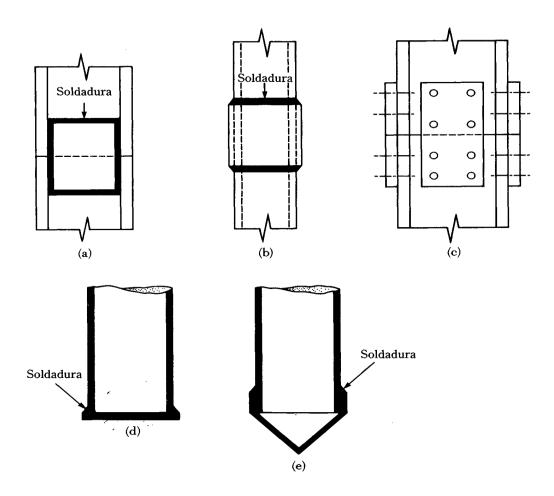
(a) empalme de pilotes H con soldadura; (b) empalme de pilotes de tubo con soldadura; (c) empalme de pilotes H con remaches y tornillos: (d) punta plana de hincado de pilote de tubo; (e) punta cónica de hincado de pilote de tubo.
